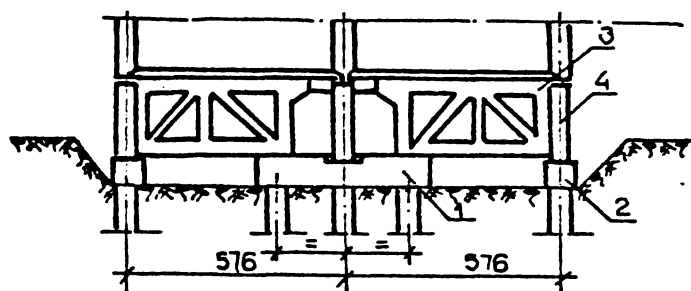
Infrastructură prefabricată pe piloți: 1 - cap frontal central; 2 - cap frontal marginal; 3 - panou elevație transv; 4 - panou elevație longitudinală.
